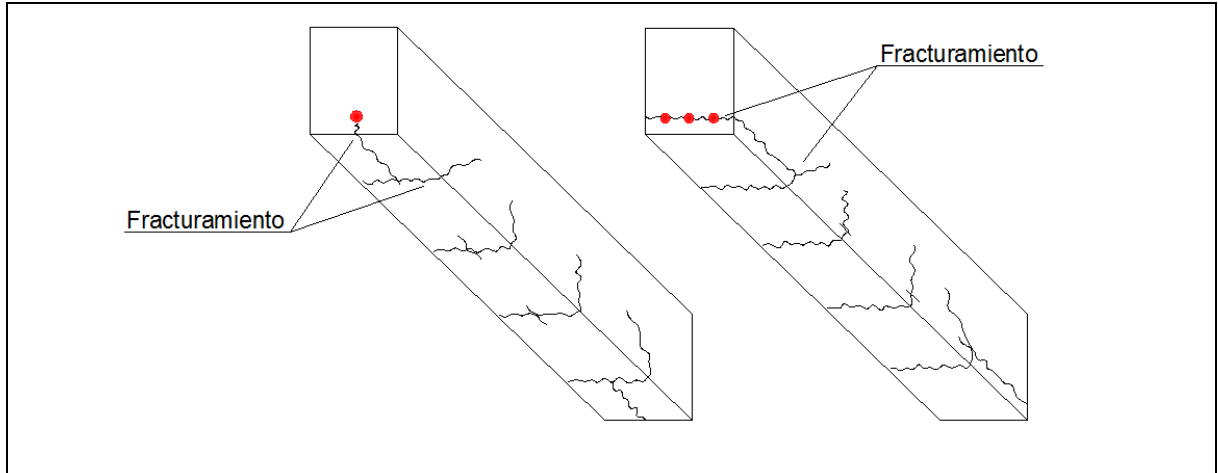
Falla por fracturamiento en una viga de concreto
